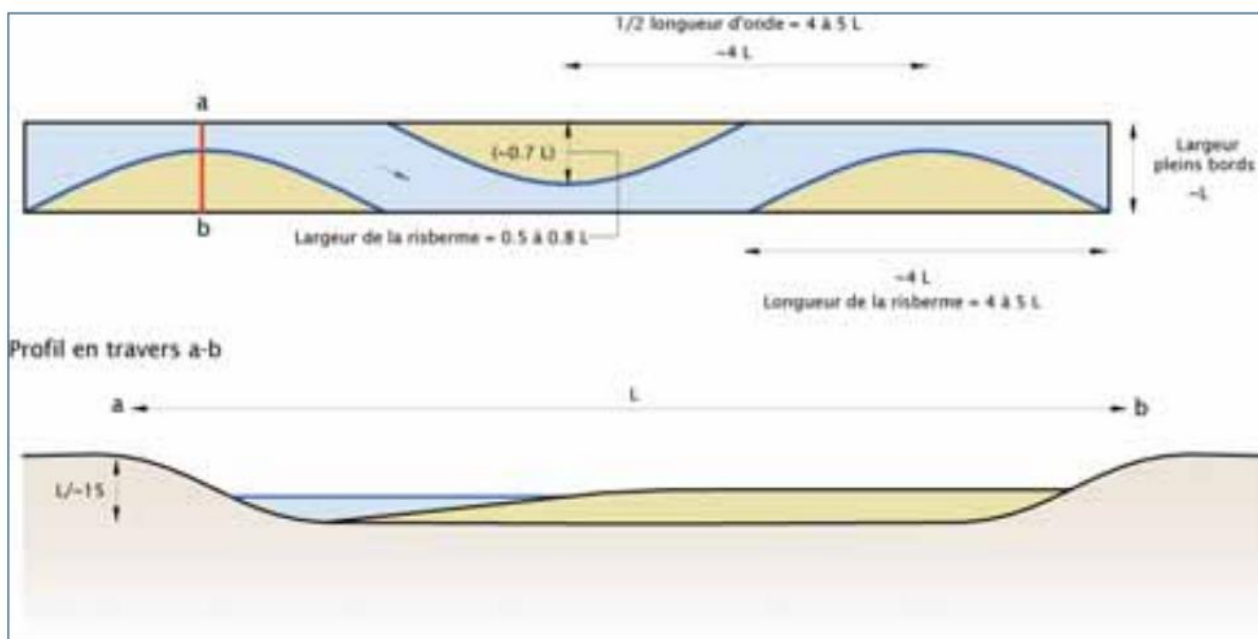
Schéma type d'implantation de banquettes alternes (source : Biotec - Malavoï)
